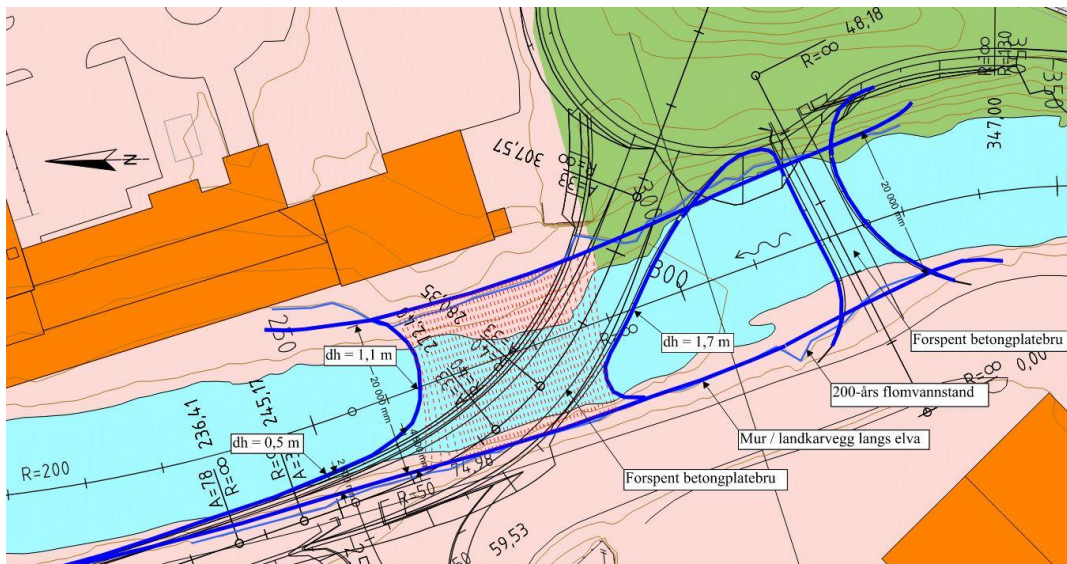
Planskisse for murer langs elva og platebruer over elva.
